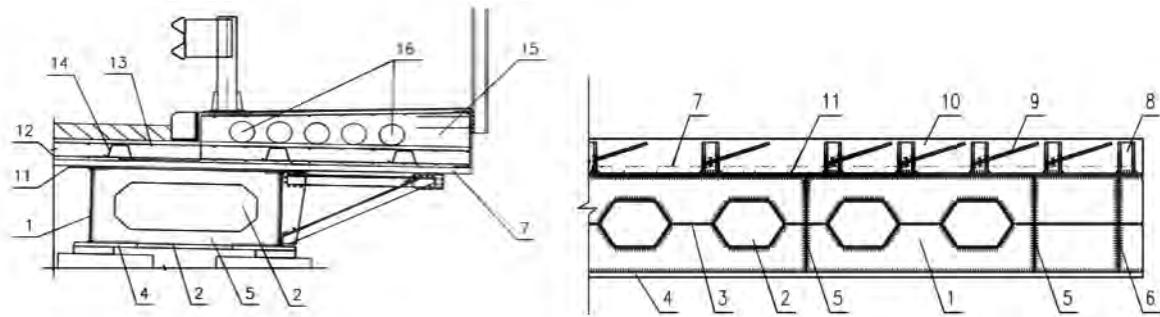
Конструкция блока пролетного строения моста: 1 – главные балки; 2 – шестиугольные отверстия; 3 – сварной шов; 4 – нижний пояс; 5 – промежуточные диафрагмы; 6 – опорные диафрагмы; 7 – профилированный лист; 8 – жесткий элемент связи сдвига; 9 – гибкий элемент связи сдвига; 10 – железобетонная плита проезжей части; 11 – верхний пояс; 12, 13 – нижняя и верхняя арматурные сетки плиты проезжей части; 14 – хомутов; 15 – тротуарный блок; 16 – неизвлекаемые вкладыши пустотообразователи
